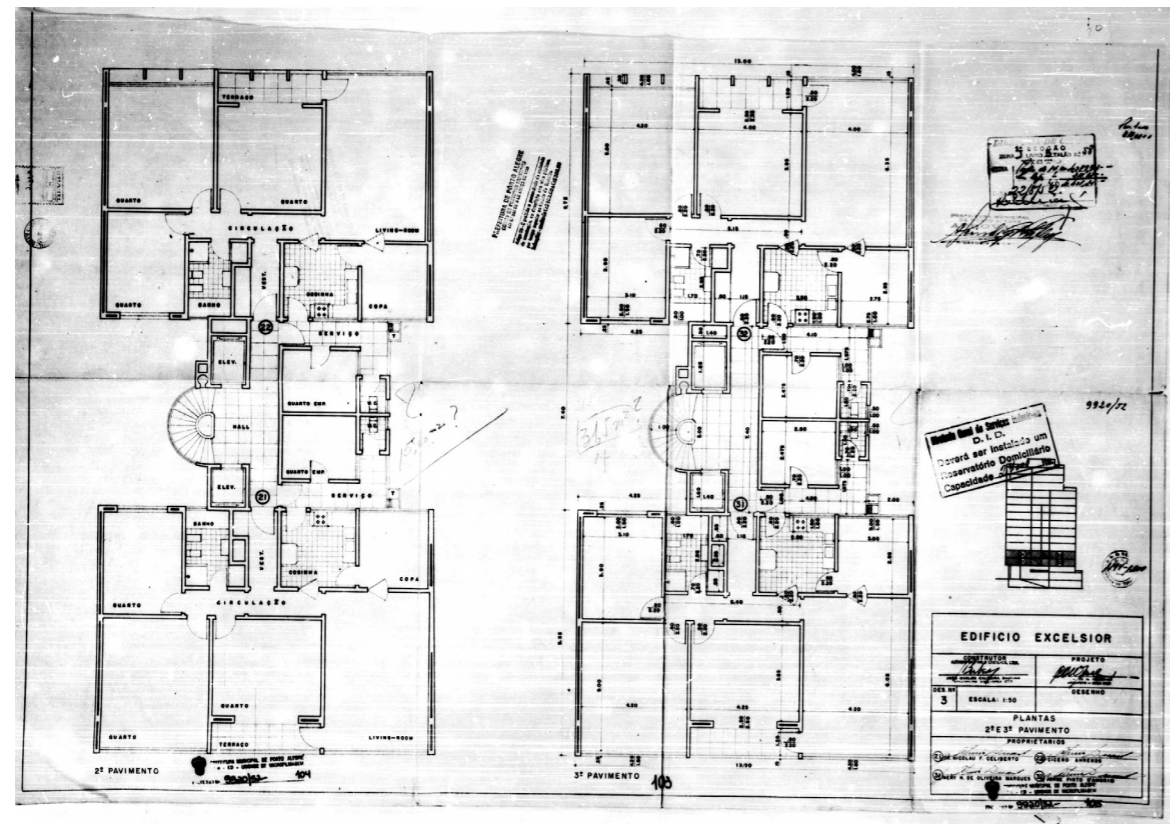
Planta Baixa 2º e 3º pavimentos do Edifício Excelsior. Fonte: BUENO, 2012.
